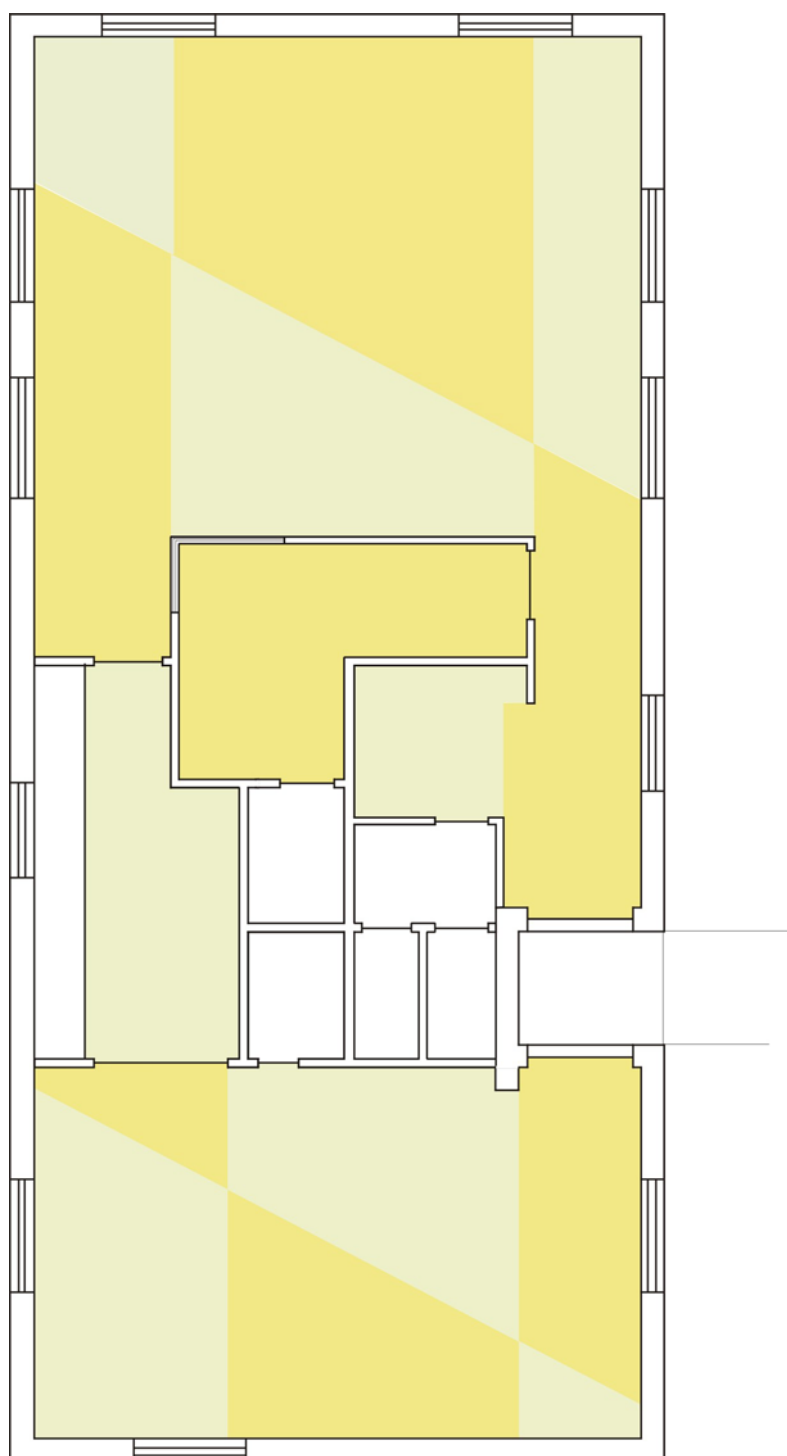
Estudo de propostas para aplicação de linóleo no pavimento
